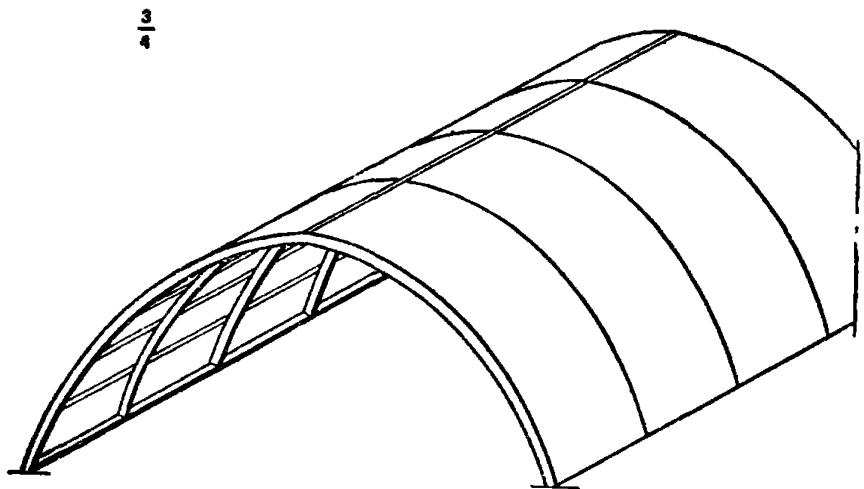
Сводчатое покрытие зданий пролетом 12–18 м с безрулонной кровлей из армоцементных цилиндрических элементов
